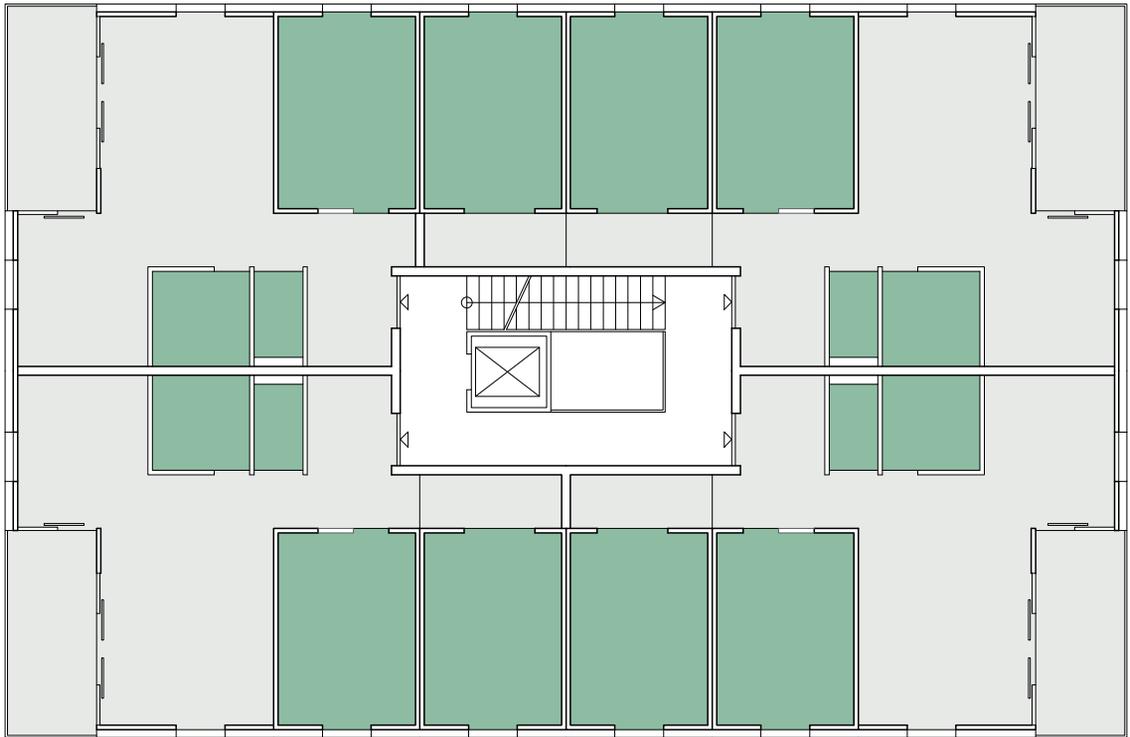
Grundrissstruktur in hybrider Raummodulbauweise
